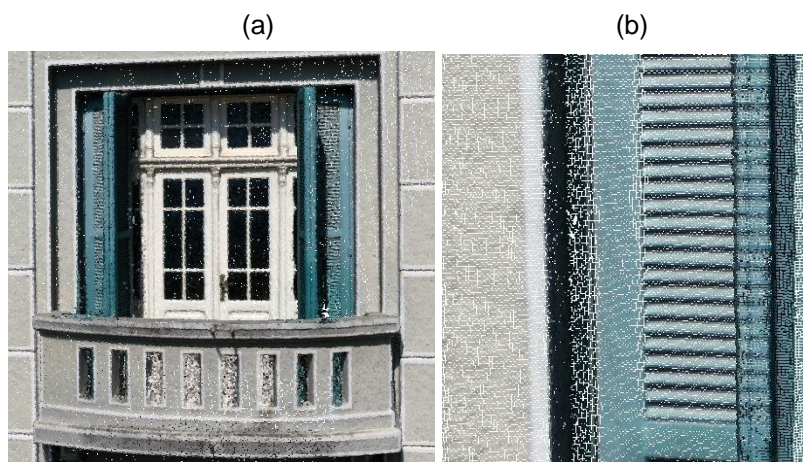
TRIDIMENSIONALIDADE DA FACHADA EXTERNA: (a) VISTA NA TRANSVERSAL;
